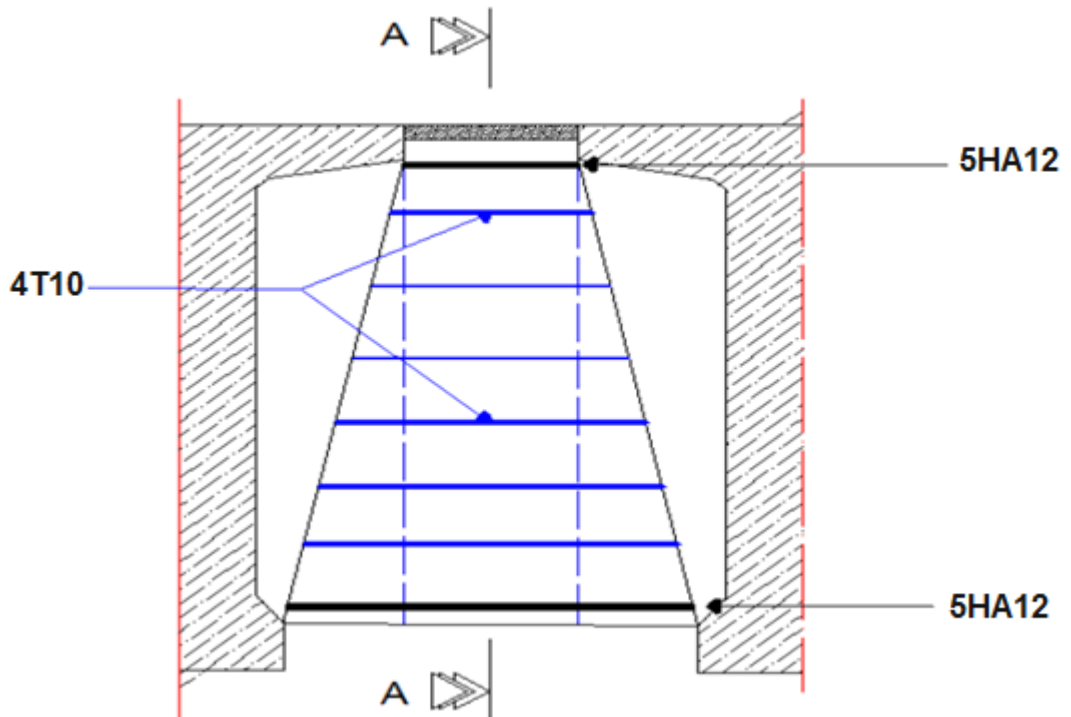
Plan de ferrailage de l'entretoise d'about
